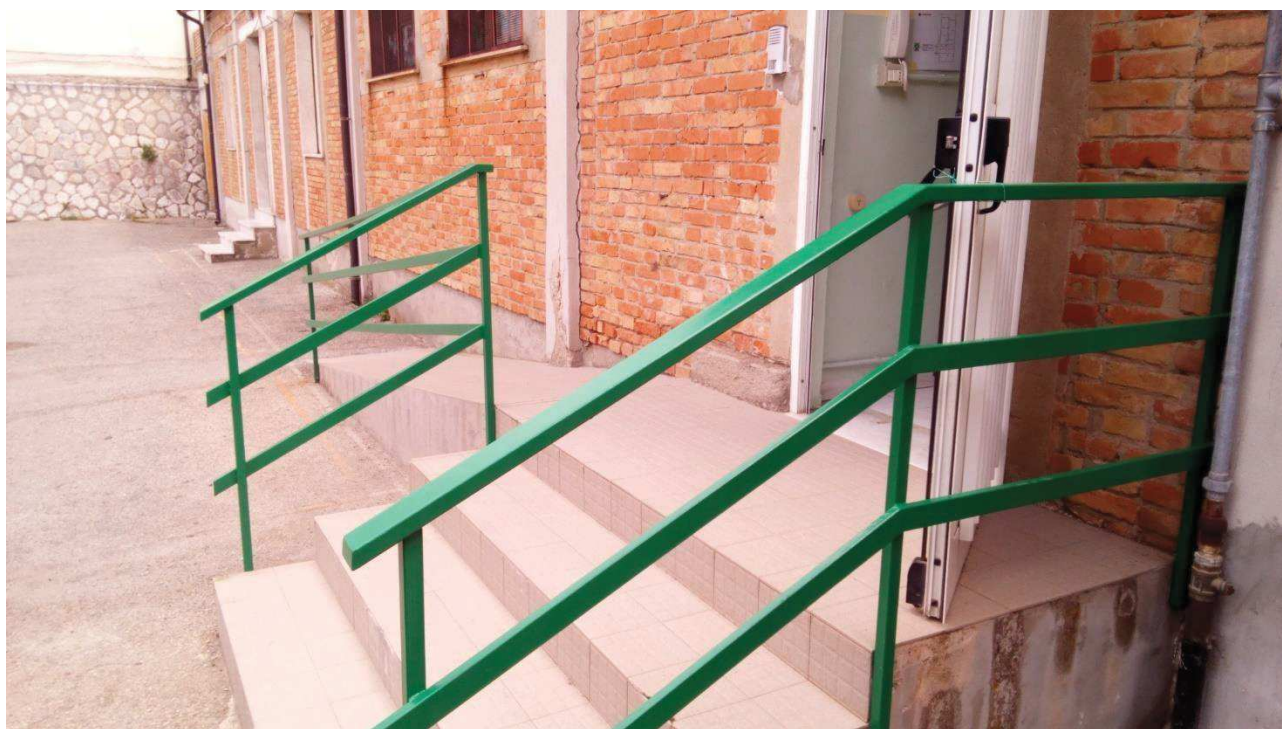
[Plesso San Pietro] Situazione ringhiere d'ingresso post operam.
